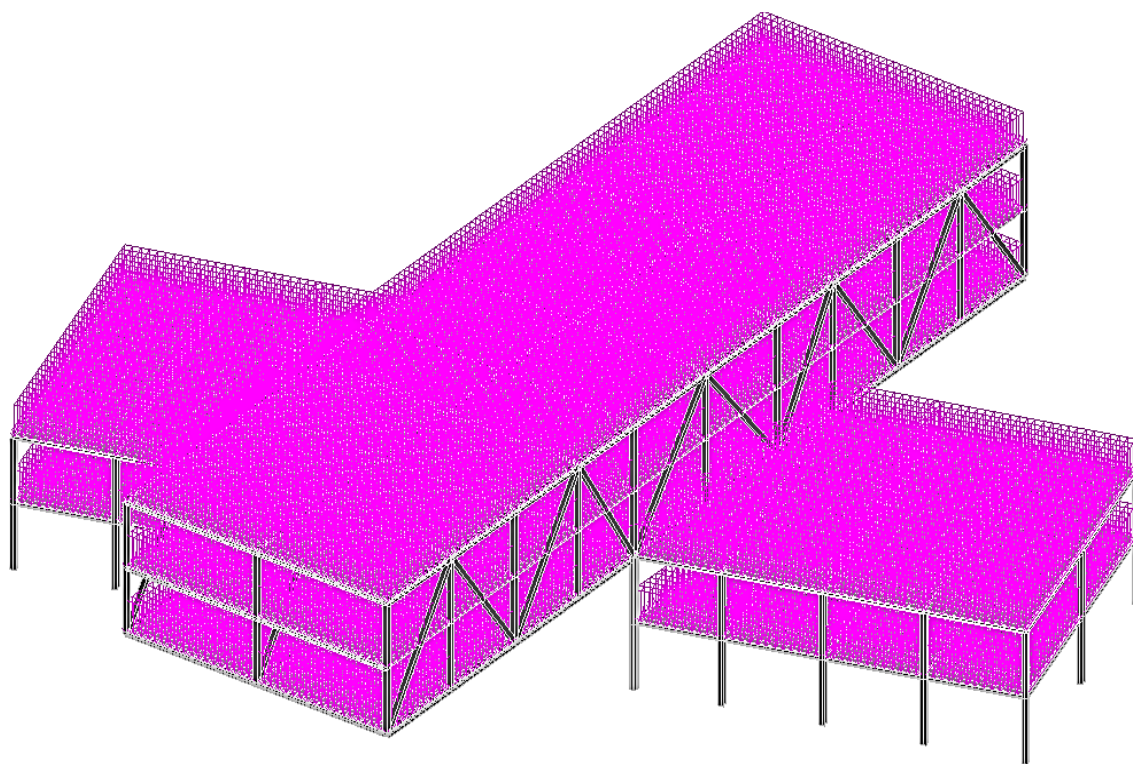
Схема прикладання власної ваги залізобетонних конструкцій
